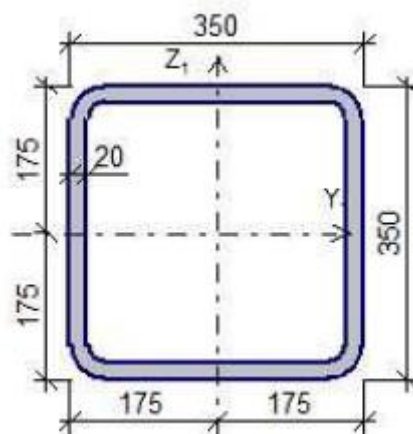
Сечение верхнего и нижнего пояса фермы
